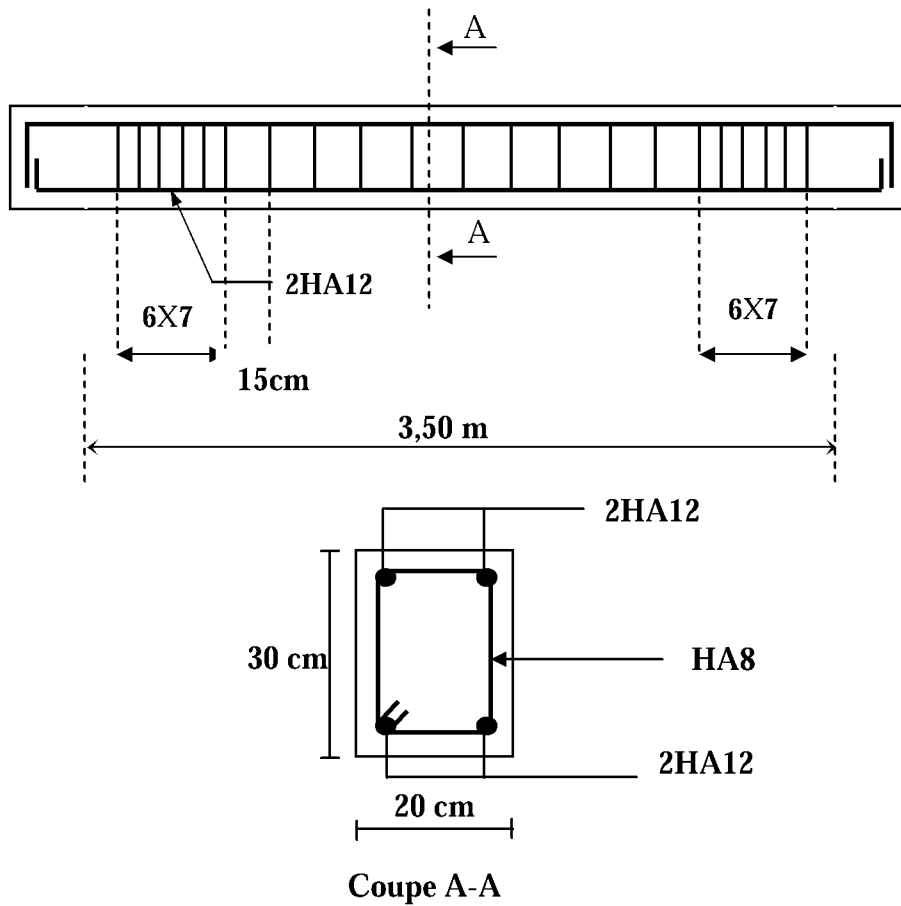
Ferrailage de la poutre de chaînage.
